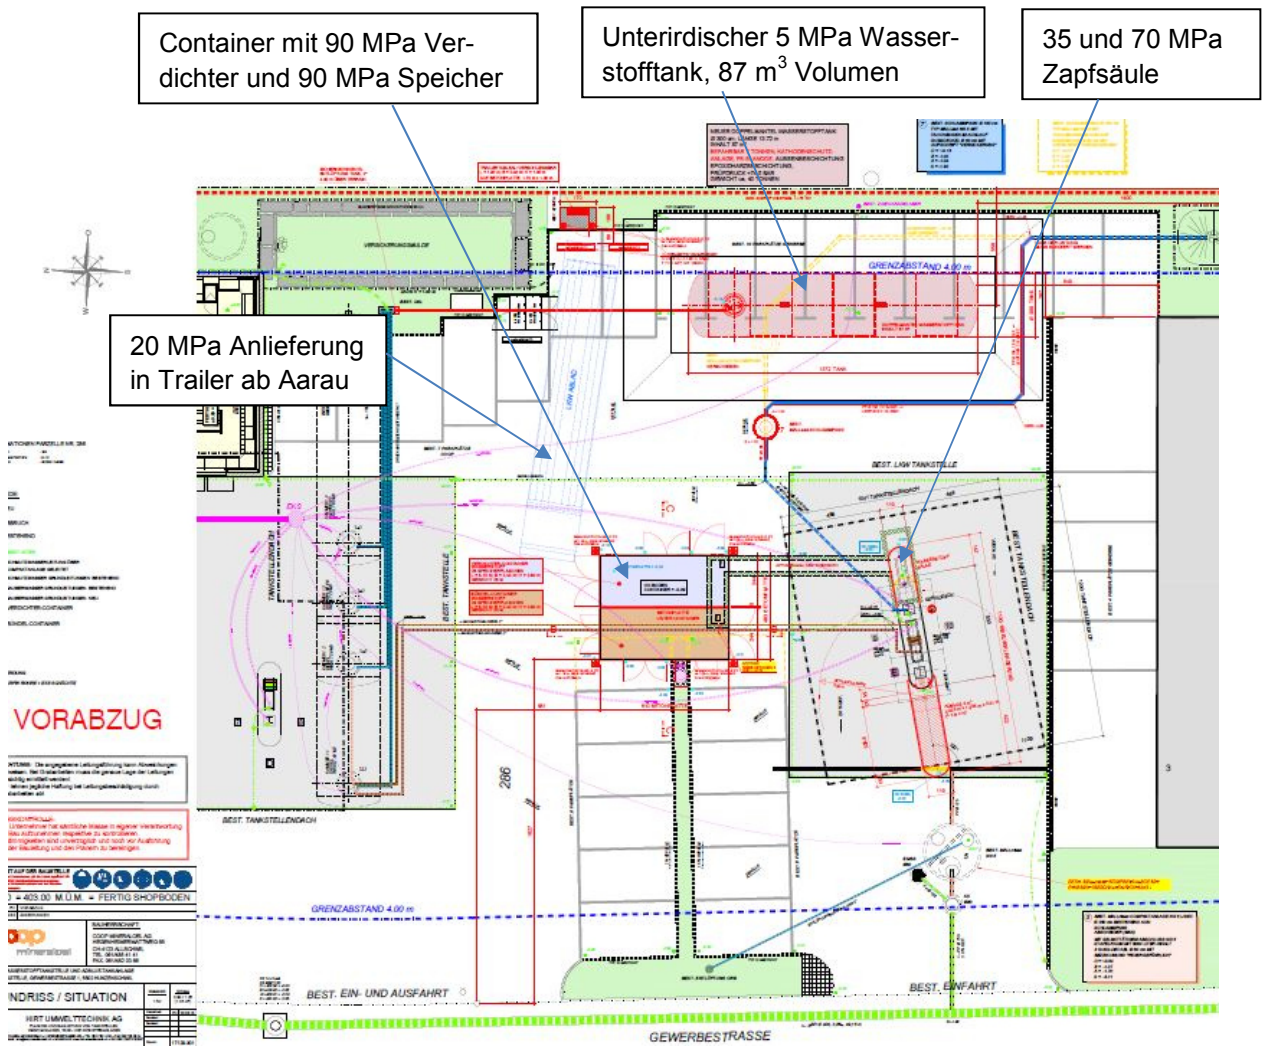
Grundriss der Tankstelle Hunzenschwil
